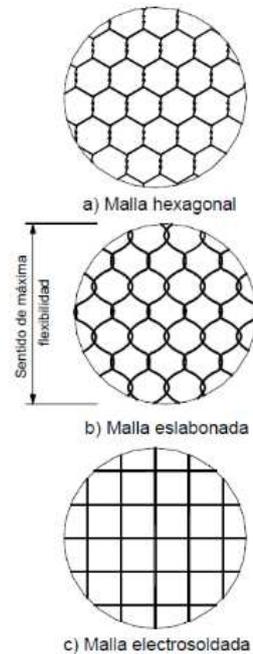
Tipos de mallas utilizadas en la construcción de gaviones. Fuente: (Suárez Díaz, 2001).
